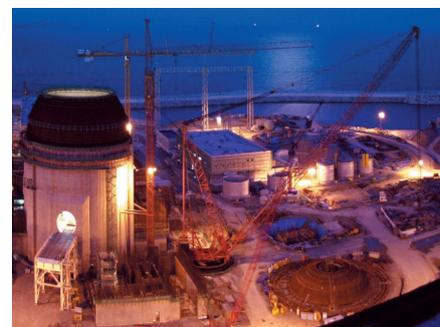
Travaux de construction de la centrale nucléaire Shin-Kori
